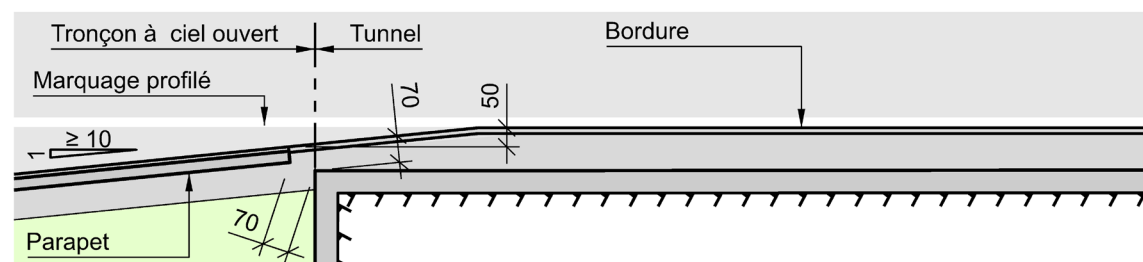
Variante 3b – Le parapet se termine avant l'entrée du tunnel
